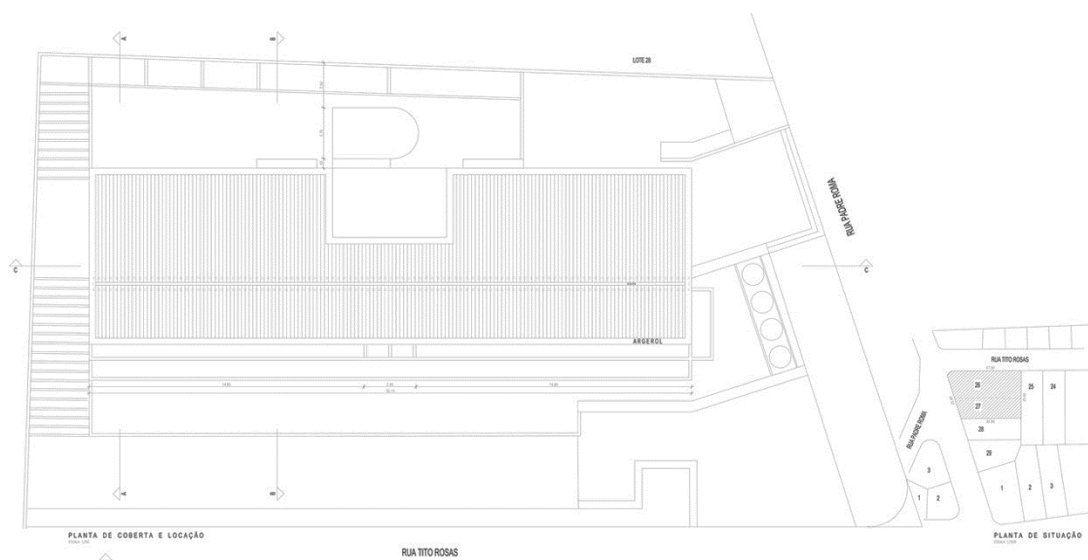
Planta de Coberta e Locação do Edifício Vila Mariana, 1976, do arquiteto Tinoco. Fonte: Elaboração própria, com base no Arquivo da Prefeitura de Recife (1976).
